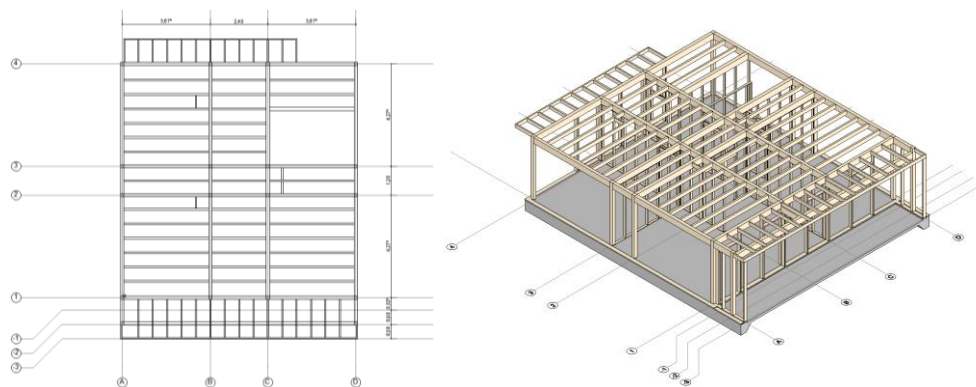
Solução alternativa para as vigas de pavimento com uma viga e pilares adicionais de suporte.
